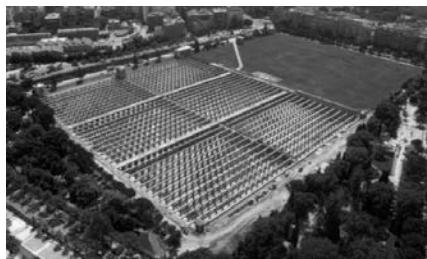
Retirada cubierta de hormigón existente en intervención sobre el Tercer Depósito [C. Lucas Serrano y J. Mata Arbide 2005]
